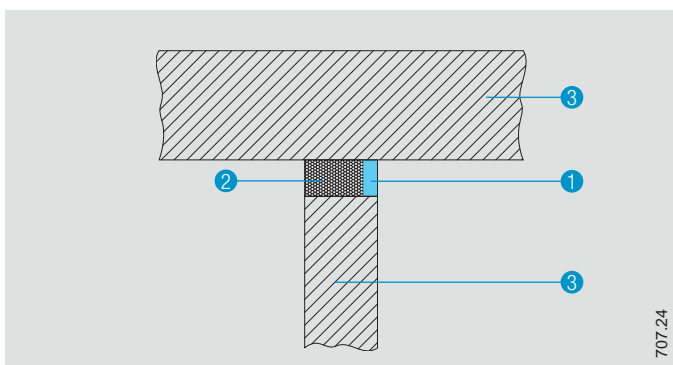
Detail D - Bauteilfuge in Massivwand mit nicht brennbarer Hinterfüllung
